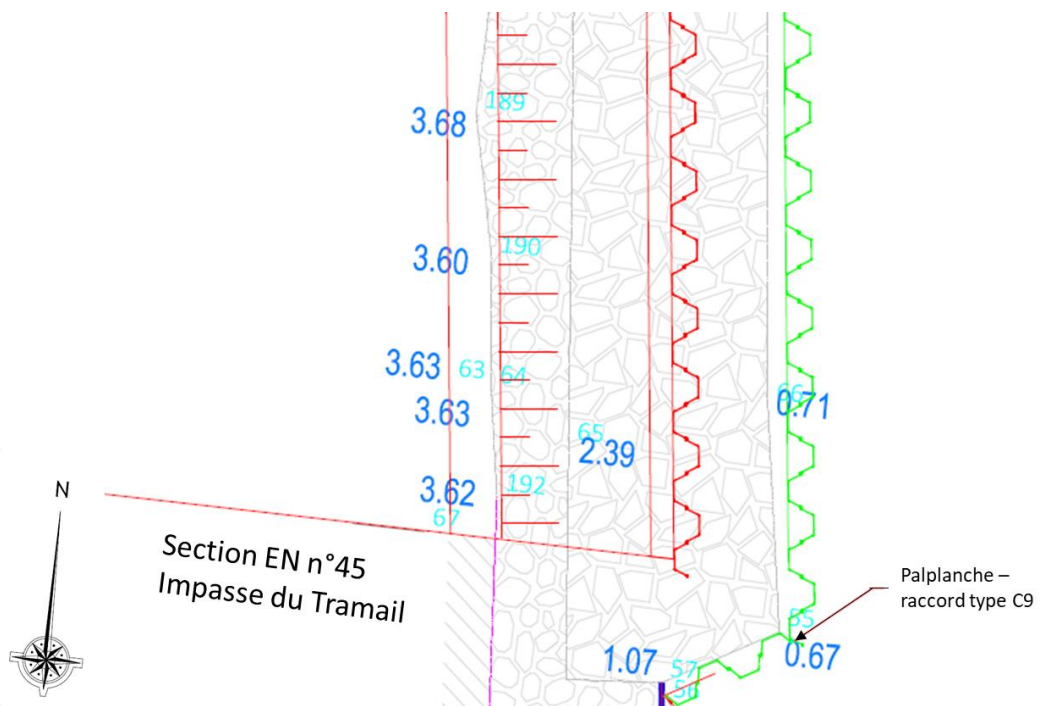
Plan du raccordement latéral de l'ouvrage dans sa partie Sud (cf. annexe 4 : plans du projet)
